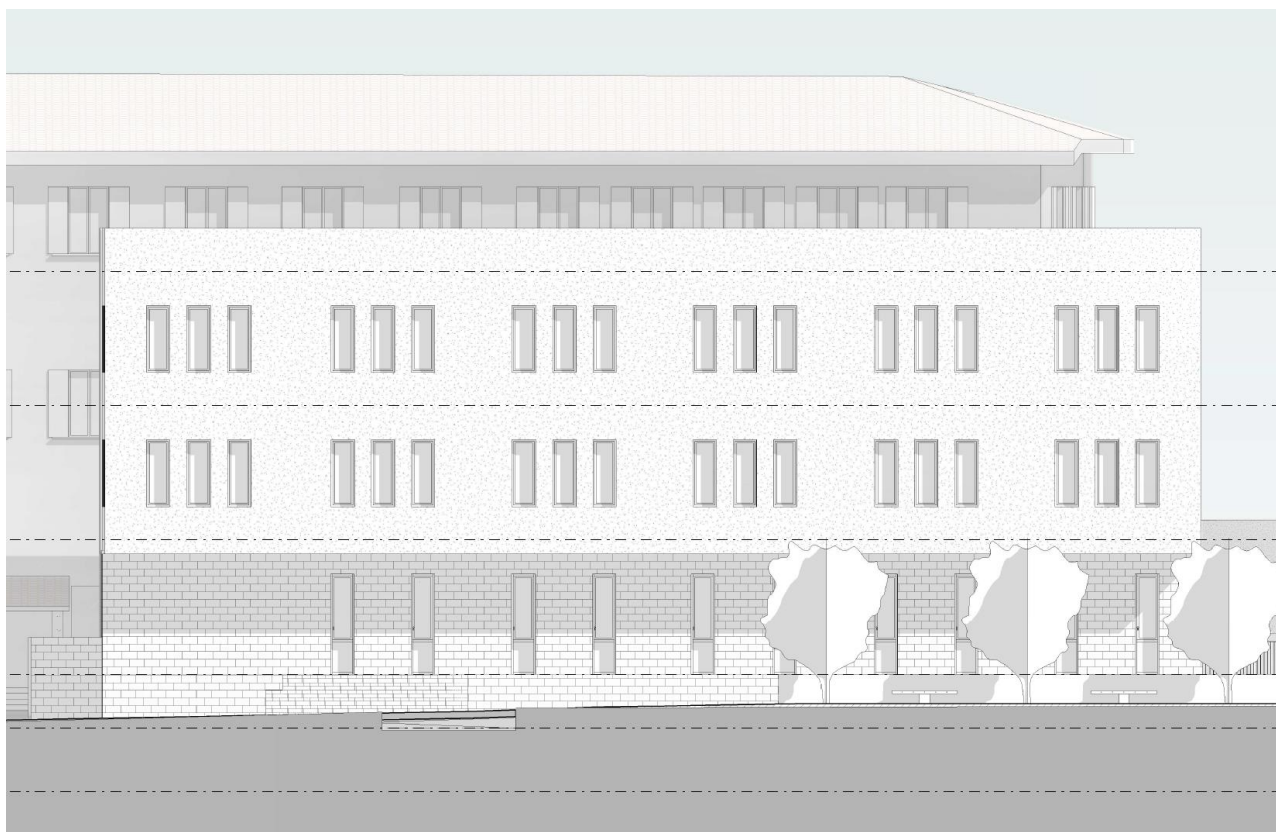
prospetto corte interna lato viale Strozzi (prospetto nord-ovest)
